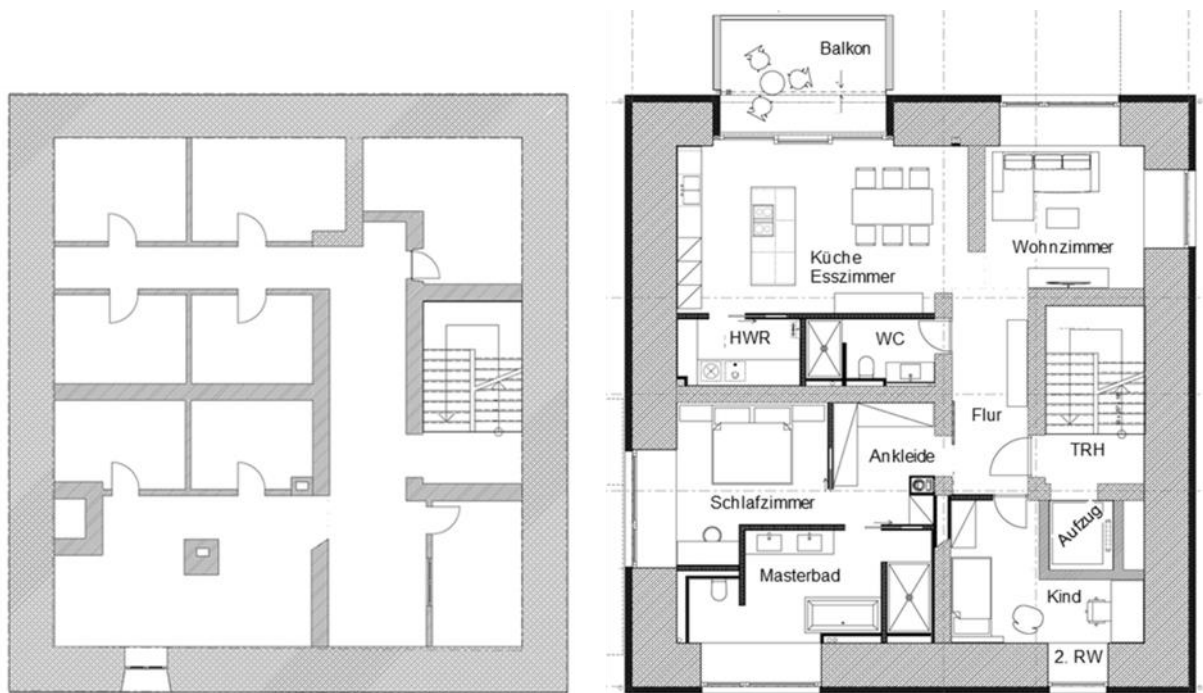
Grundriss - vor und nach der Umnutzung³⁶
